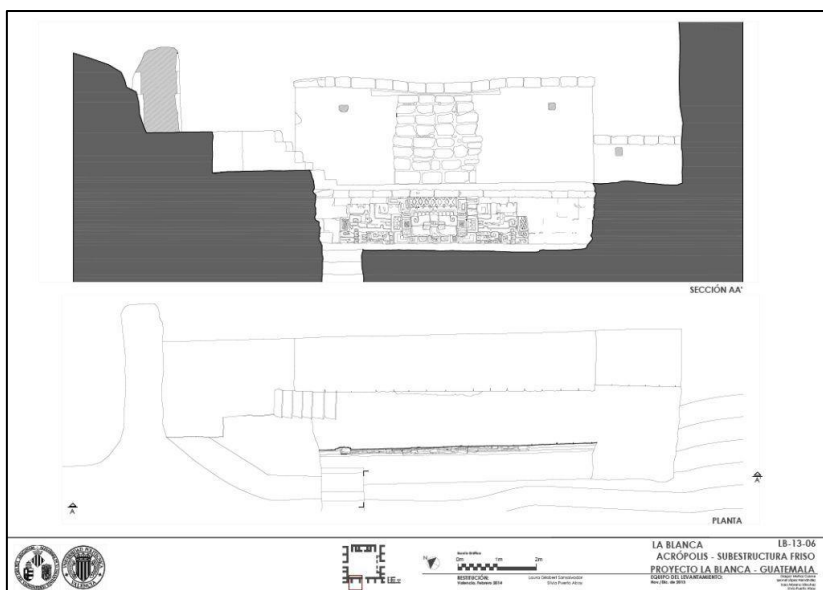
Alzado y planta del lado norte de la 6J2 Sub2, con el relieve en su parte inferior (Vidal y Muñoz eds., 2014b).
